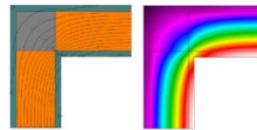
Figura 2.13: Puente térmico por geometría. Muro perimetral esquina al exterior.
